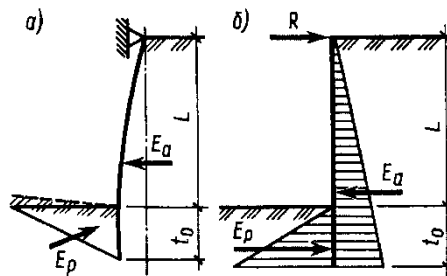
Расчет заанкеренной стенки схеме Э.К.Якоби:
